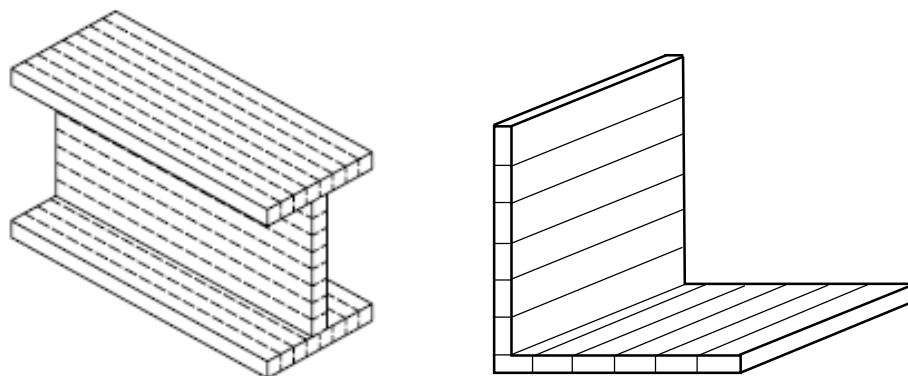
Seções transversais em perfil “I” e cantoneira divididas em fatias
